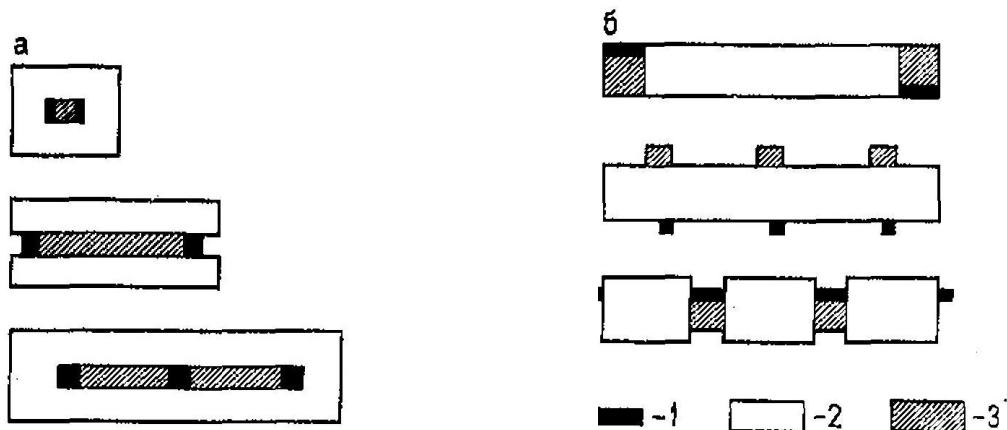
Горизонтальне зонування багатопверхових промислових будівель (схеми планів):
